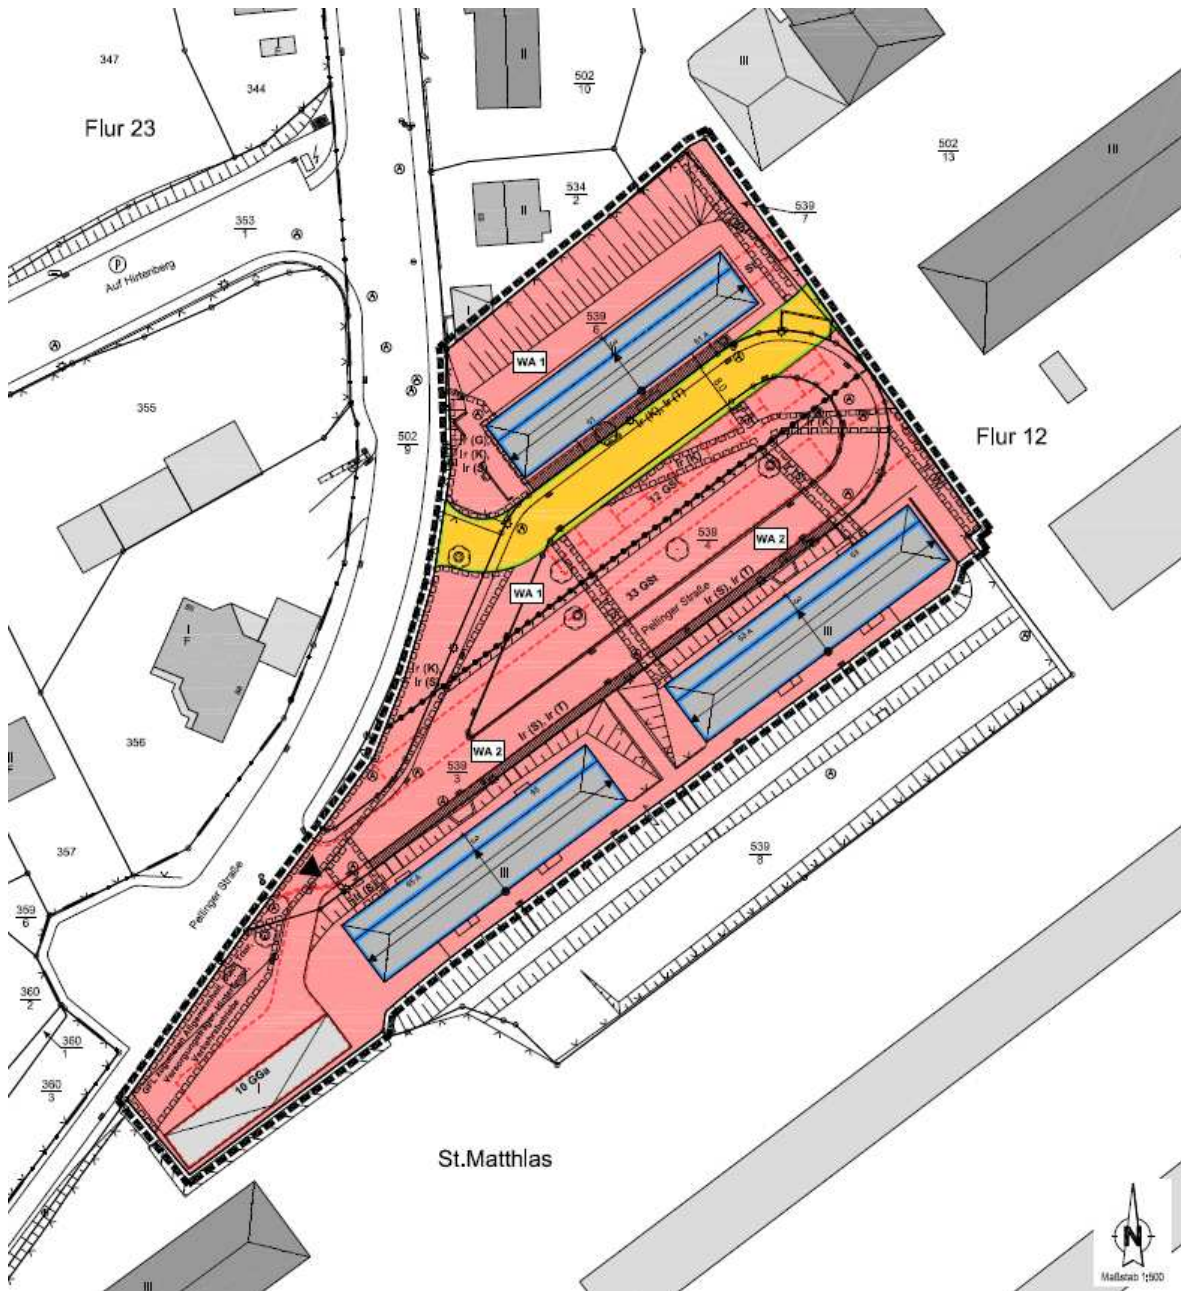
Übersicht Bebauungsplan BF 16-1
